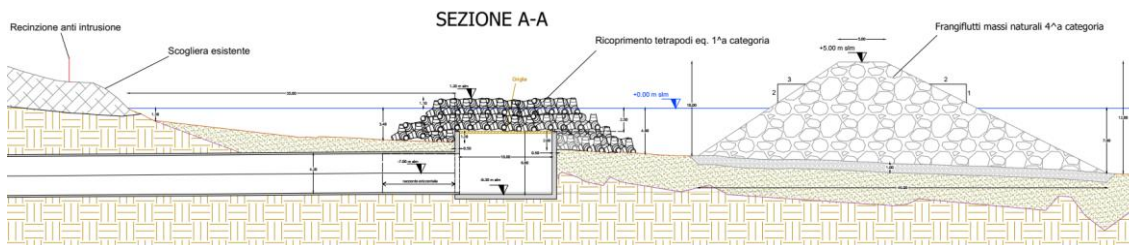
Sezione longitudinale dell'opera di presa e restituzione di valle
